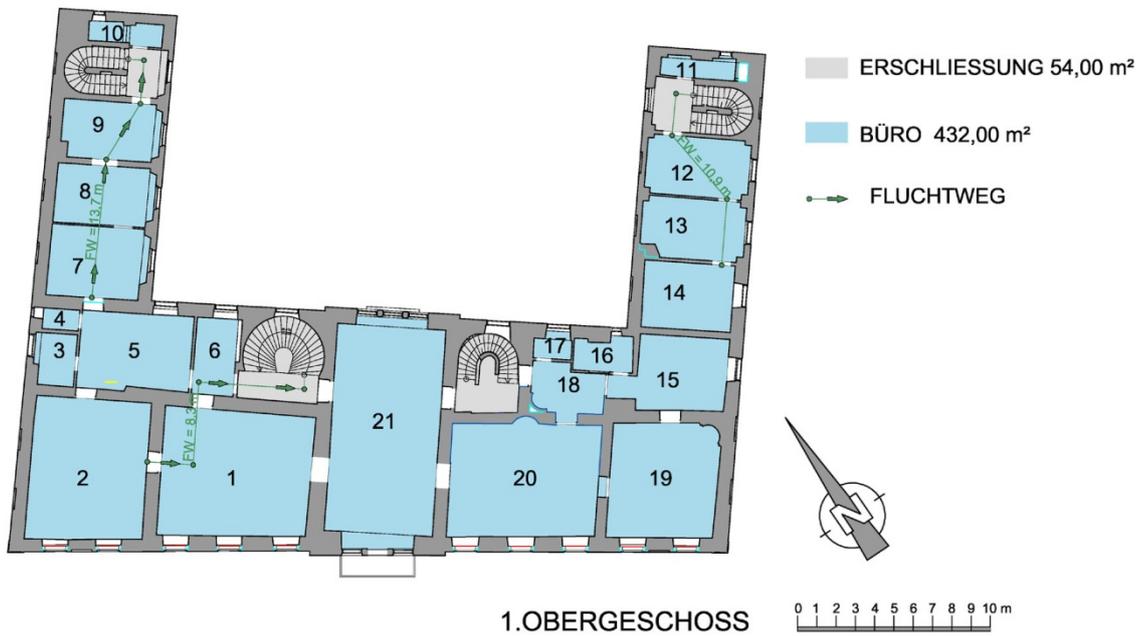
zeigt den Grundriss des Schlosses Süssenbrunn
